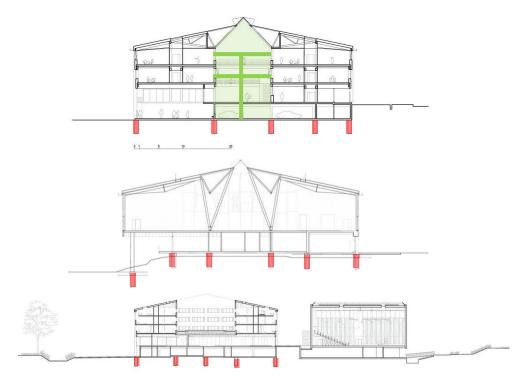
Esquema estructural del Colegio Internado Liceo Nelson Mnadela Fuente: Archidally. 2014
